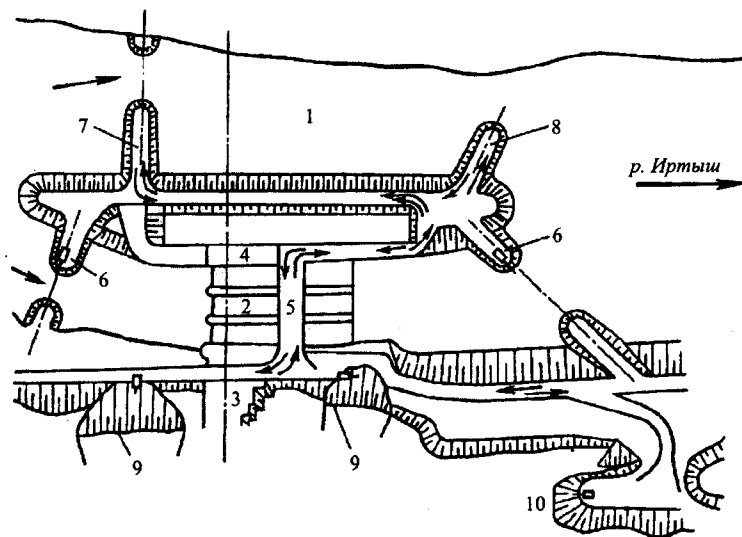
Схема пионерного перекрытия р. Иртыша на Бухтарминской ГЭС:
